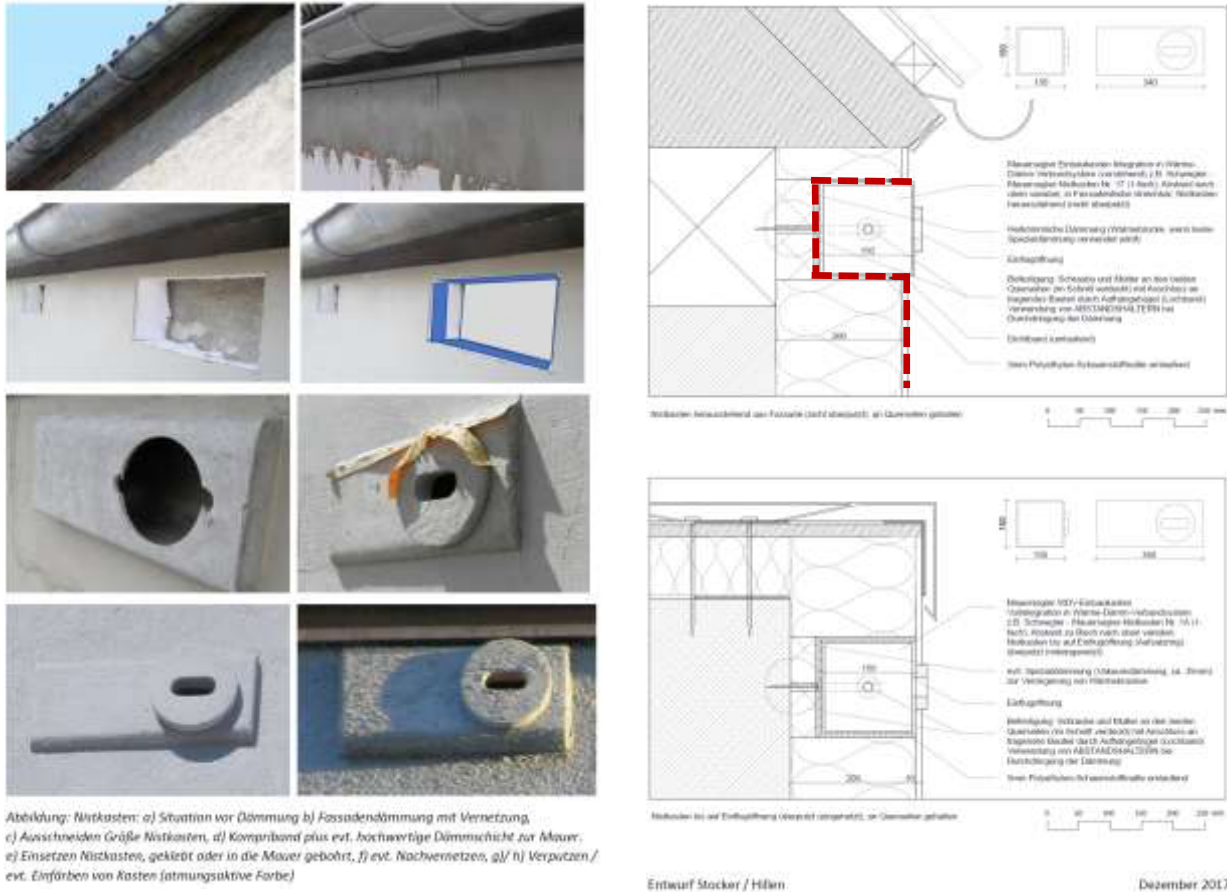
Detail 2: Mauersegger, In Wärmedämmung leicht vorstehend
